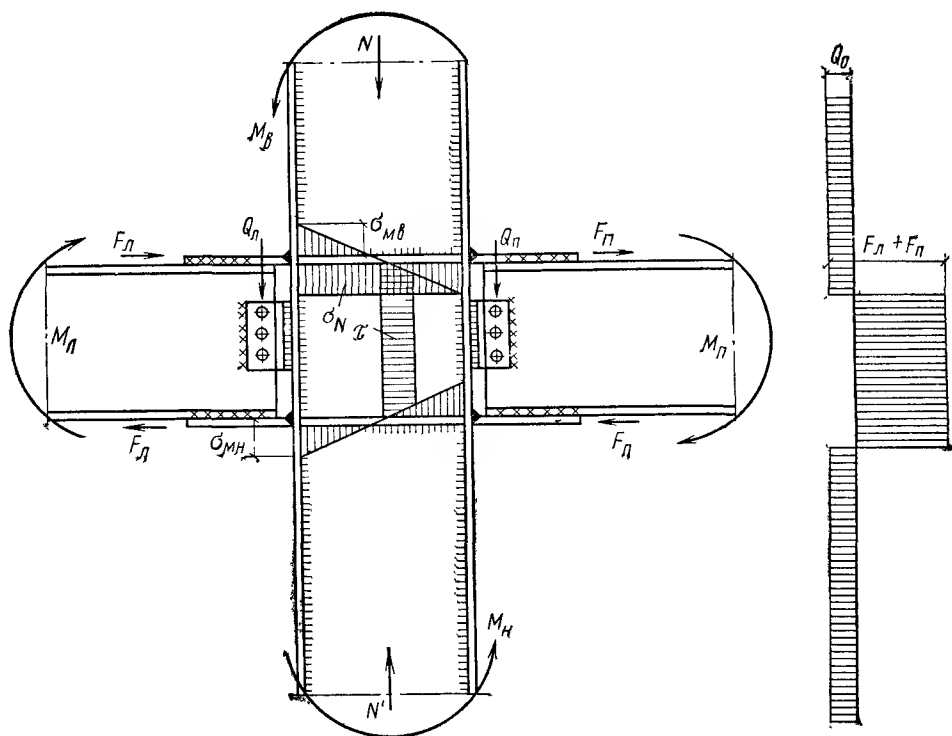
Напряженное состояние в стенке колонны рамного узла
